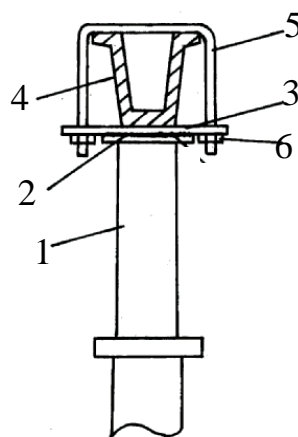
Затискне пристосування для з'єднання металевих гідравлічних стояків тимчасового кріплення підсилення з верхняком із СВП: 1 – висувна частина стояка з опорою 2 і привареної до неї планкою 3; 4 – СВП; 5 – скоба; 6 – гайка
